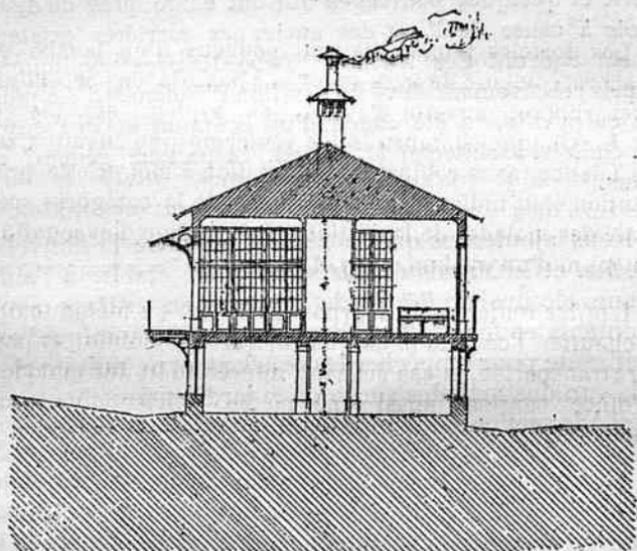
Coupe sur la ligne AB du plan (fig. 1).
